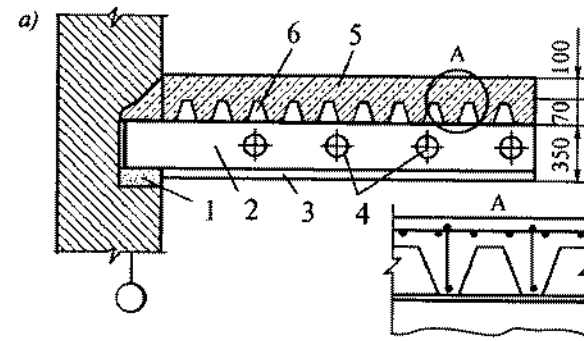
Схемы возведения перекрытий в несъемной опалубке:
